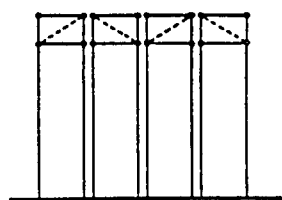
Disposição transversal das peças pré-fabricadas de quatro membros
